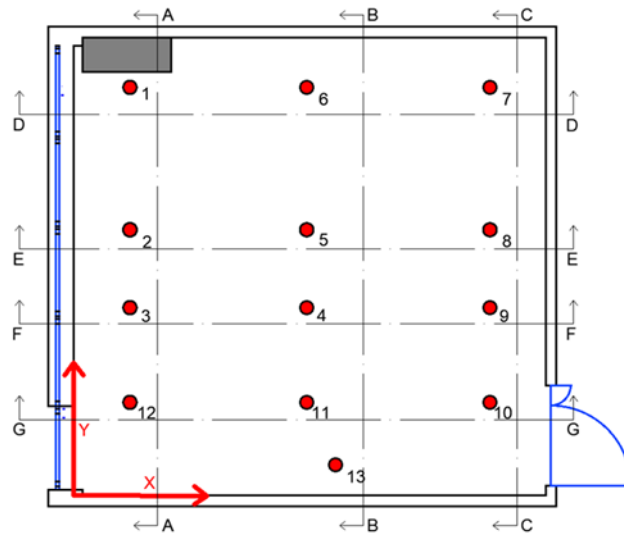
Planimetria con individuazione delle sezioni di riferimento: D-D; E-E; F-F; G-G
